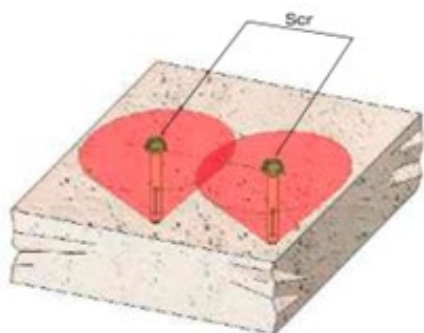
Zona crítica de colocación de fijaciones metálicas.
